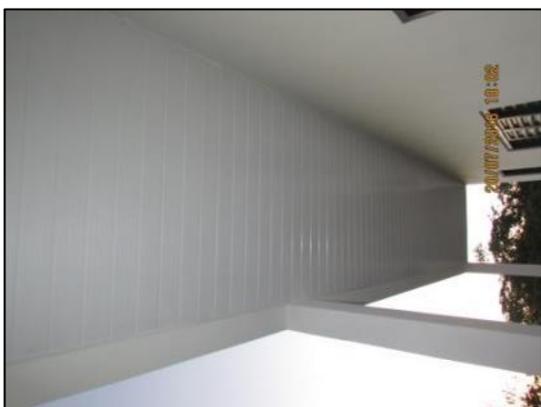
Jul/16: Instalação de forro de PVC na área da varanda externa à edificação.
